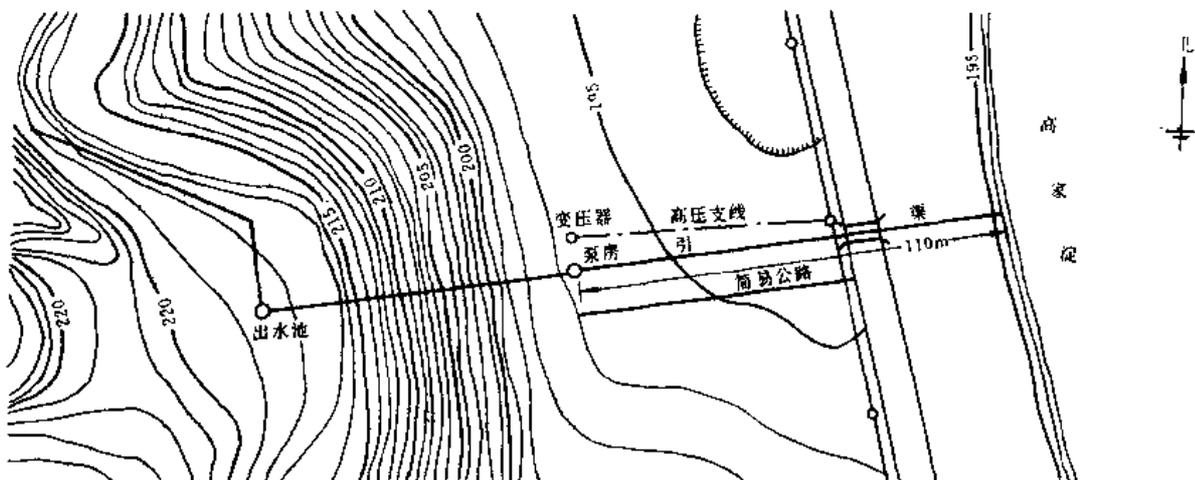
灌溉泵站总体枢纽布置示意图 (单位: m)
